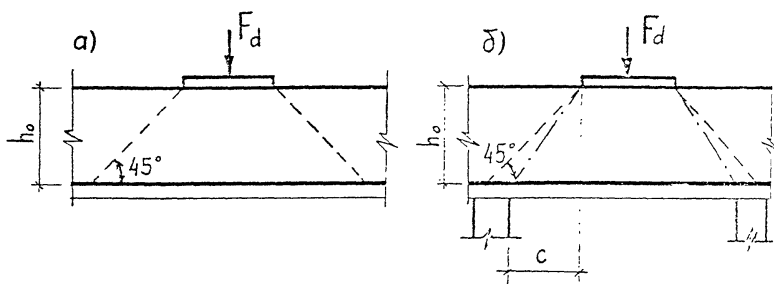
Схемы для расчета железобетонных элементов на продавливание
